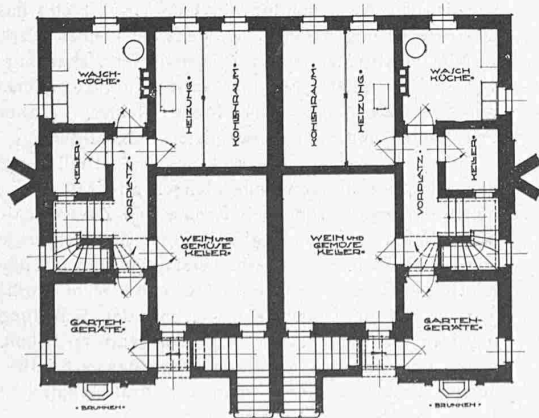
Grundriss vom Kellergeschoss.
